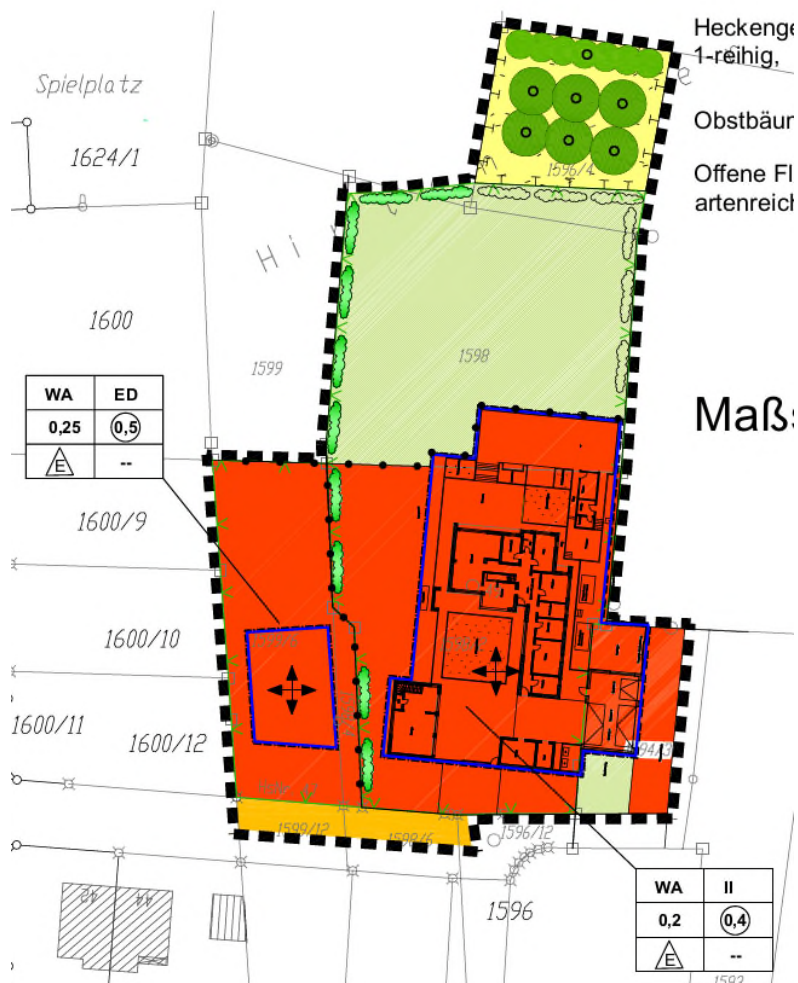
Vorentwurf der 3. Änderung Bebauungsplan „Birkenstraße Nord“
